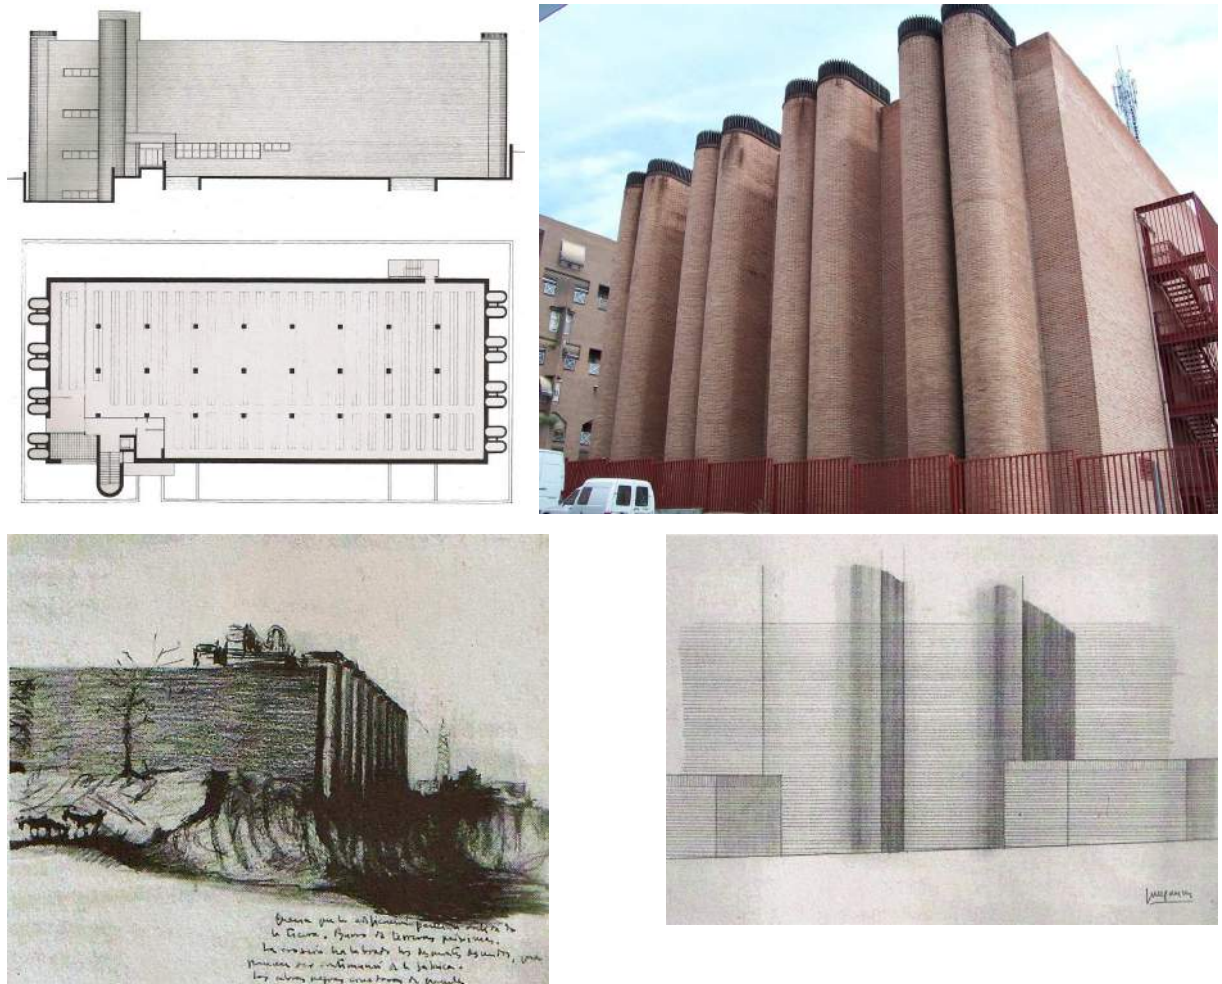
Central telefónica del Barrio de La Concepción (Madrid), 1969-1971, Julio Cano Lasso. Arriba a la izquierda, alzado y planta, nótese la regularidad geométrica de ésta (Cano Lasso, 1998, p. 98). A su derecha, vista en julio de 2007 (Colección propia del autor). Abajo, dos muestras de la maestría como dibujante del arquitecto. En el boceto de la izquierda, hace anotaciones sobre el paisaje de su emplazamiento y repara en el detalle de las cabras que por entonces pastaban en esa zona. (Cano Lasso, 1998, p. 98).
